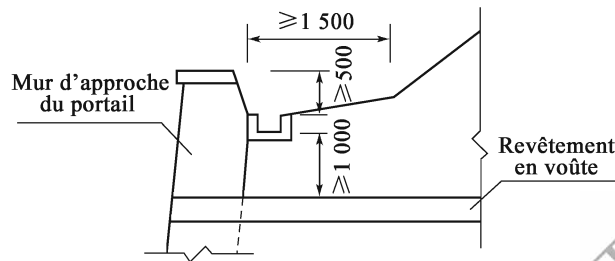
Structure en haut du dos de mur de portail (unité : mm)
